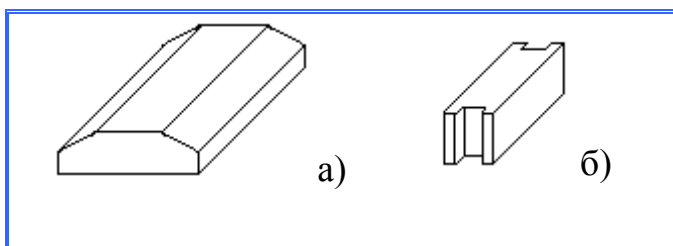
Збірні залізобетонні елементи фундаментів для громадських і житлових будівель: а) блок фундаментний; б) блок стін підвалів.
